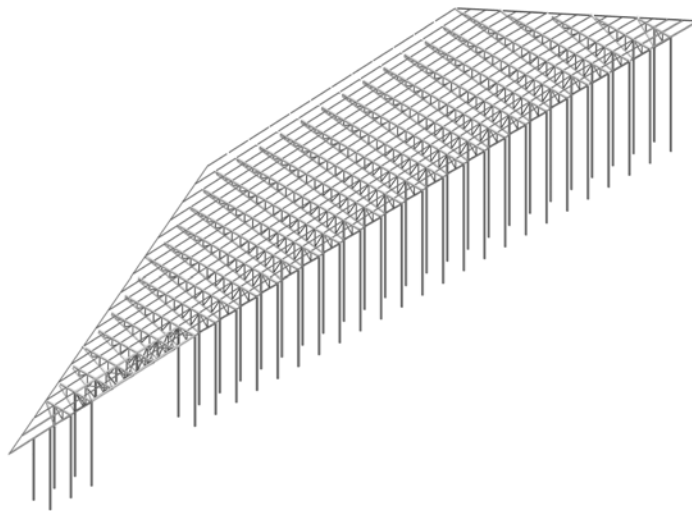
Vista 3D del progetto con gli arcarecci tra le travi reticolari.
